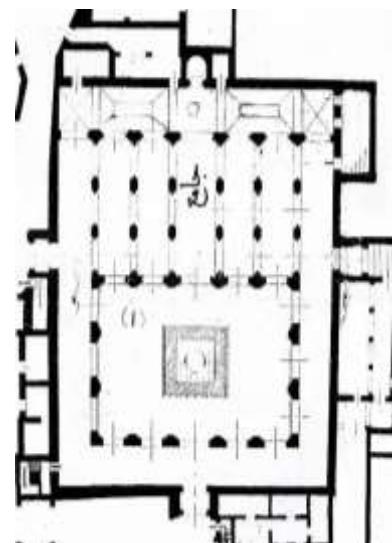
مسقط أفقى لجامع المواسين بمراكش
